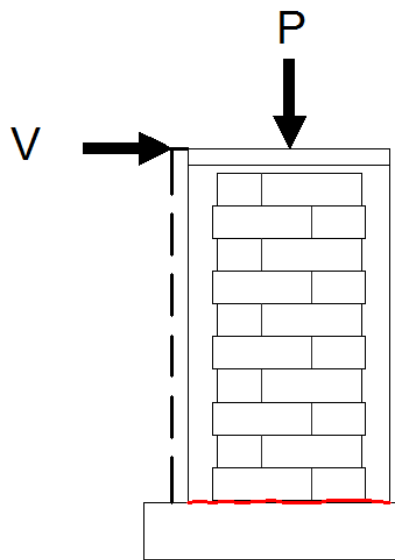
Grieta de flexo-cortante en un muro confinado
